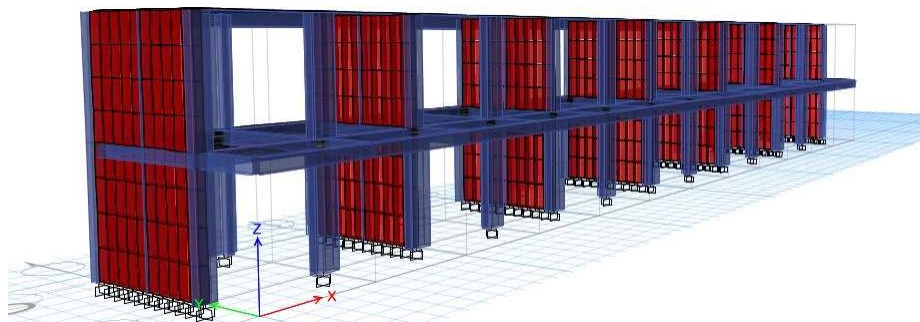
Modelamiento estructural en Etabs2018 del plan de refuerzo 1
